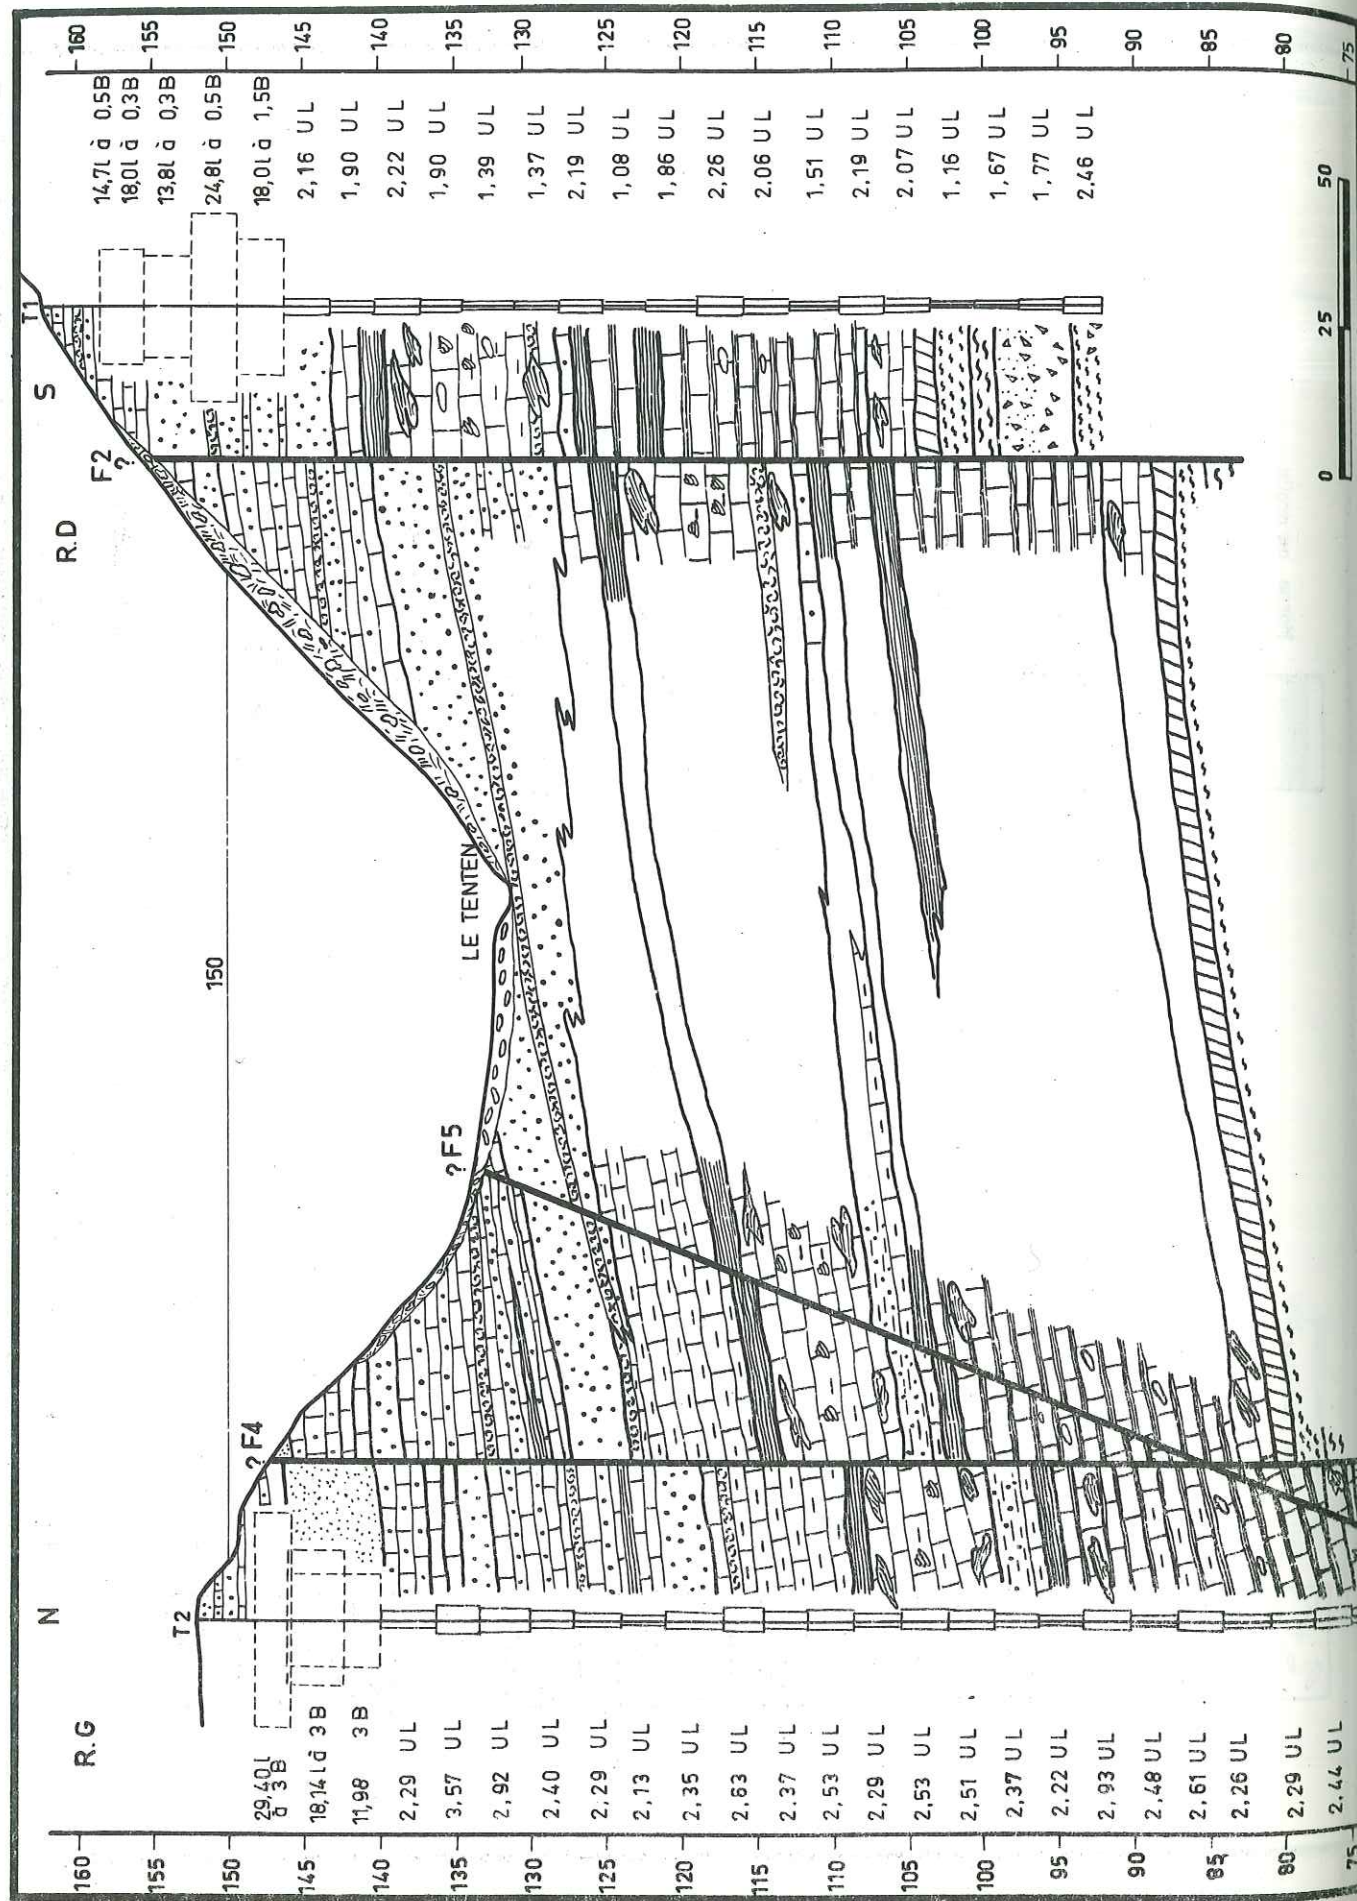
COUPE GÉOLOGIQUE DU SITE DU BARRAGE DE JONQUIÈRES AVEC LES ESSAIS D'EAU
